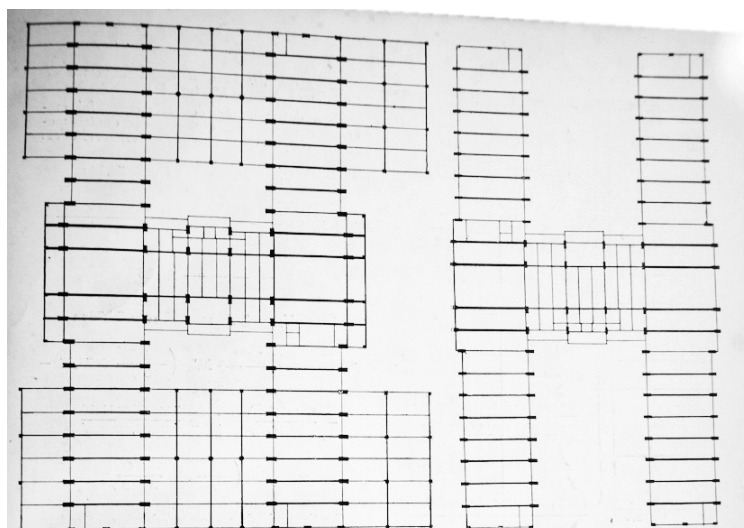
Esq. Esquema de estrutura do 1. Pavimento. Dir. Esquema de estrutura dos pavimentos superiores. FONTE: CONCRETO, 1938.
